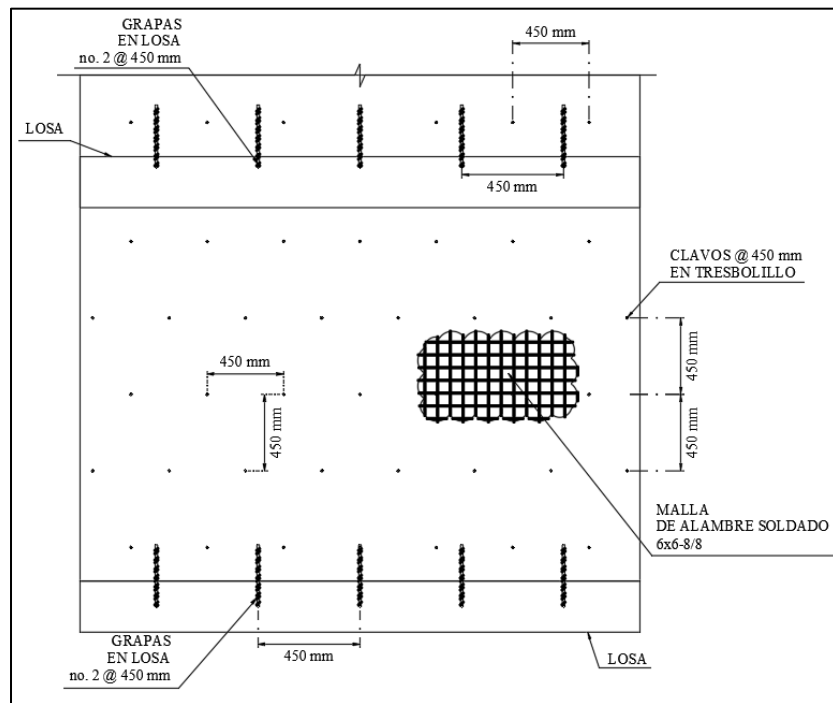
Distribución de anclaje en muros encamisados del edificio Roma Sur.
